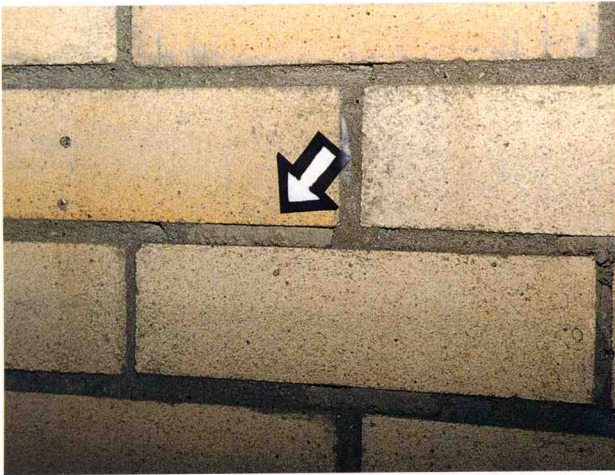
炉背面目地部分の剝離及びひび割れ状況
